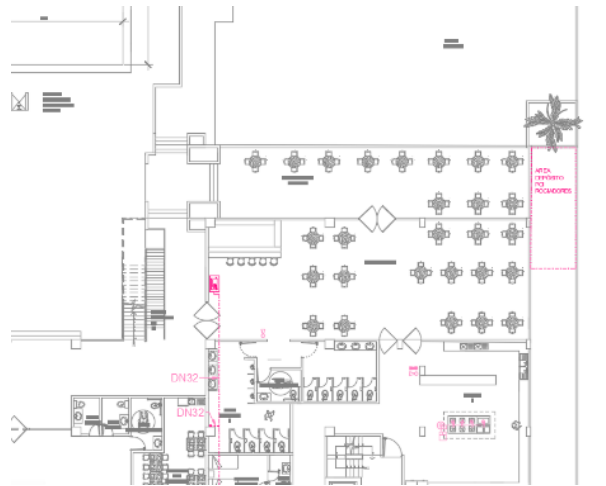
Previsión cuarto bombeo de rociadores en fachada norte planta baja. Planos del proyecto
